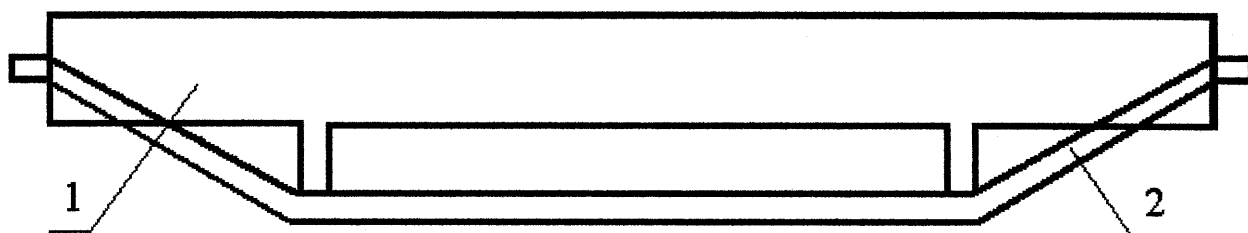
Шпренгельная конструкция на основе бетона и стеклопластика
